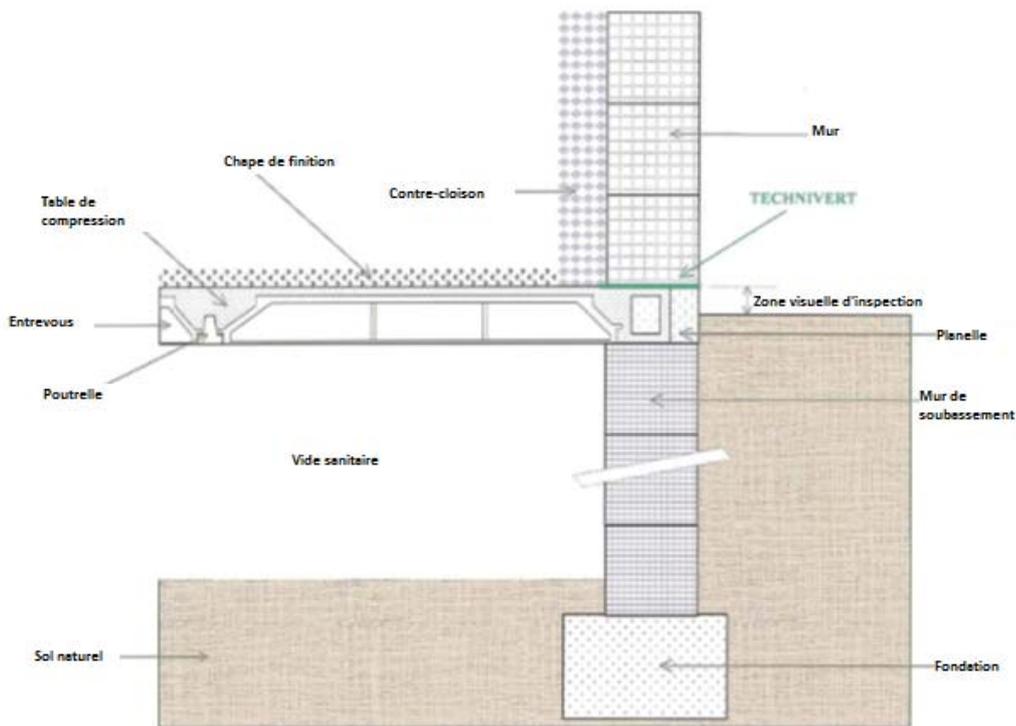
Coupe sur vide sanitaire accessible au sens du DTU 65.10
